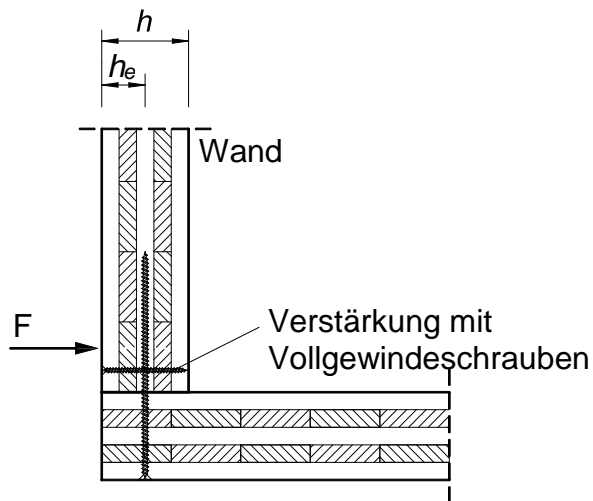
Verstärkung einer Brettsperrholzwand mit Vollgewinde Schrauben
